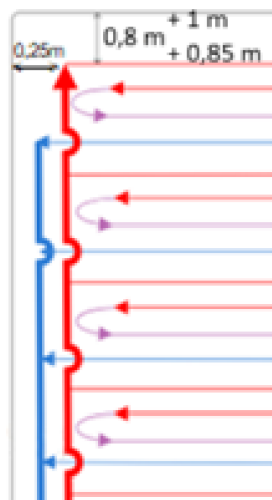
Layout uppvärmningssystemets flödesschema, ej korrekt antal rader
